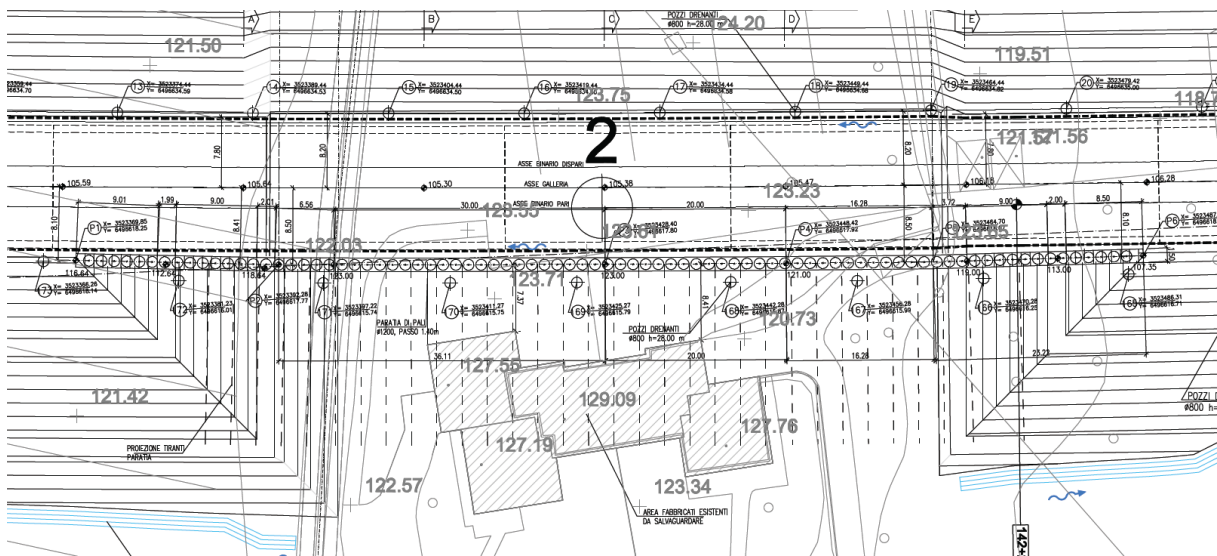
Planimetria della paratia di pali a protezione dell'edificio alla progressiva 142+200 ca.
